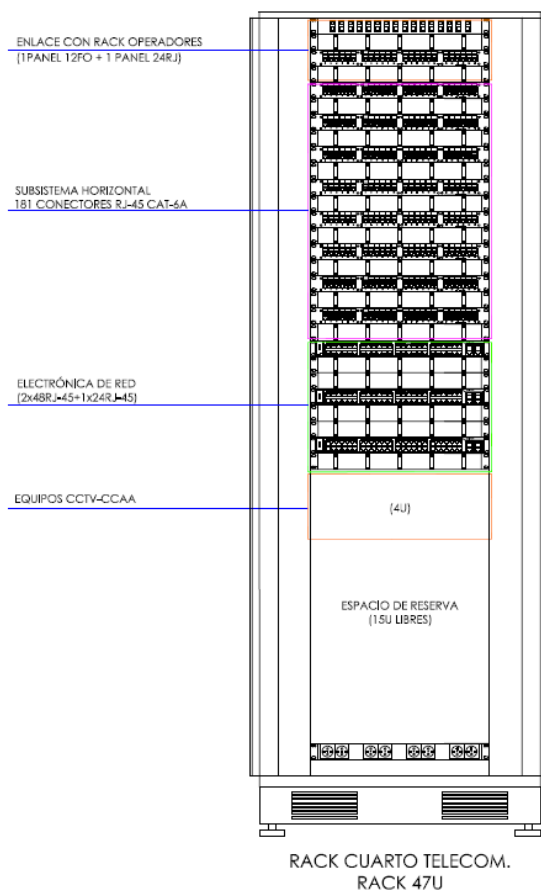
Detalle del armario Rack principal – Rack A
